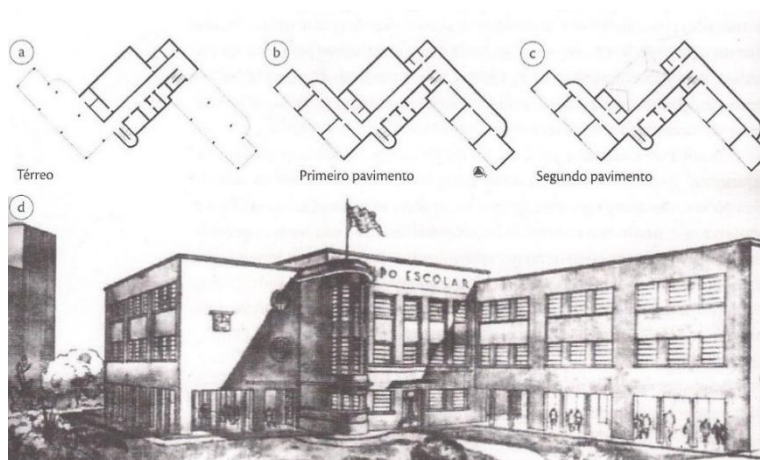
Grupo Escolar Visconde Congonhas do Campo, Plantas e vista. Fonte: Kowaltowski, 2011, p. 88
